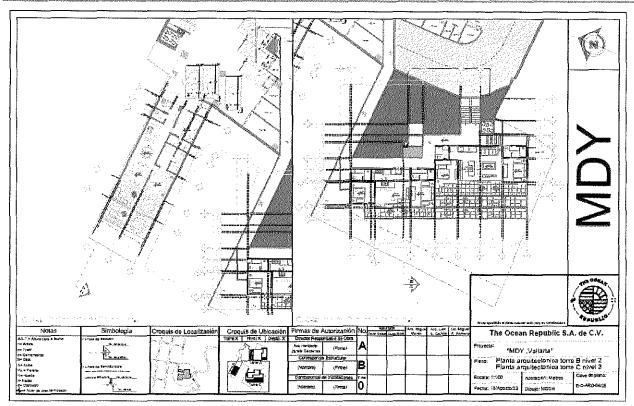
Planta arquitectónica torre B nivel 2. Planta arquitectónica torre C nivel 3
